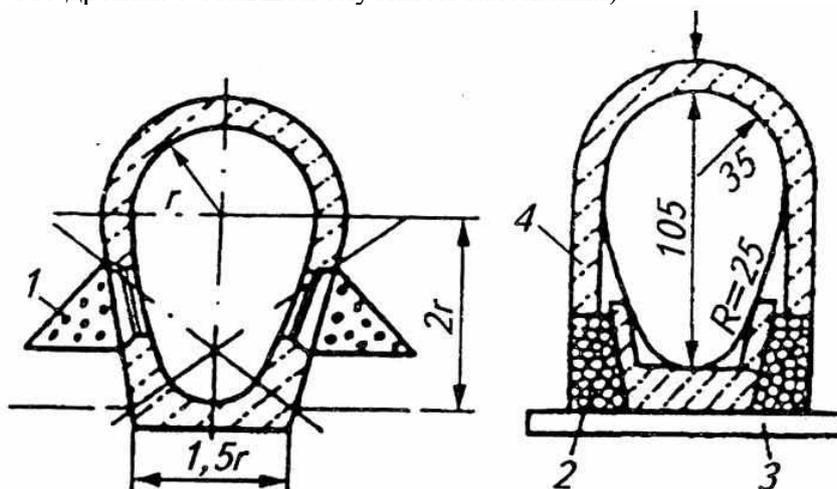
Железобетонные галереи овоидальной формы (размеры в см)
